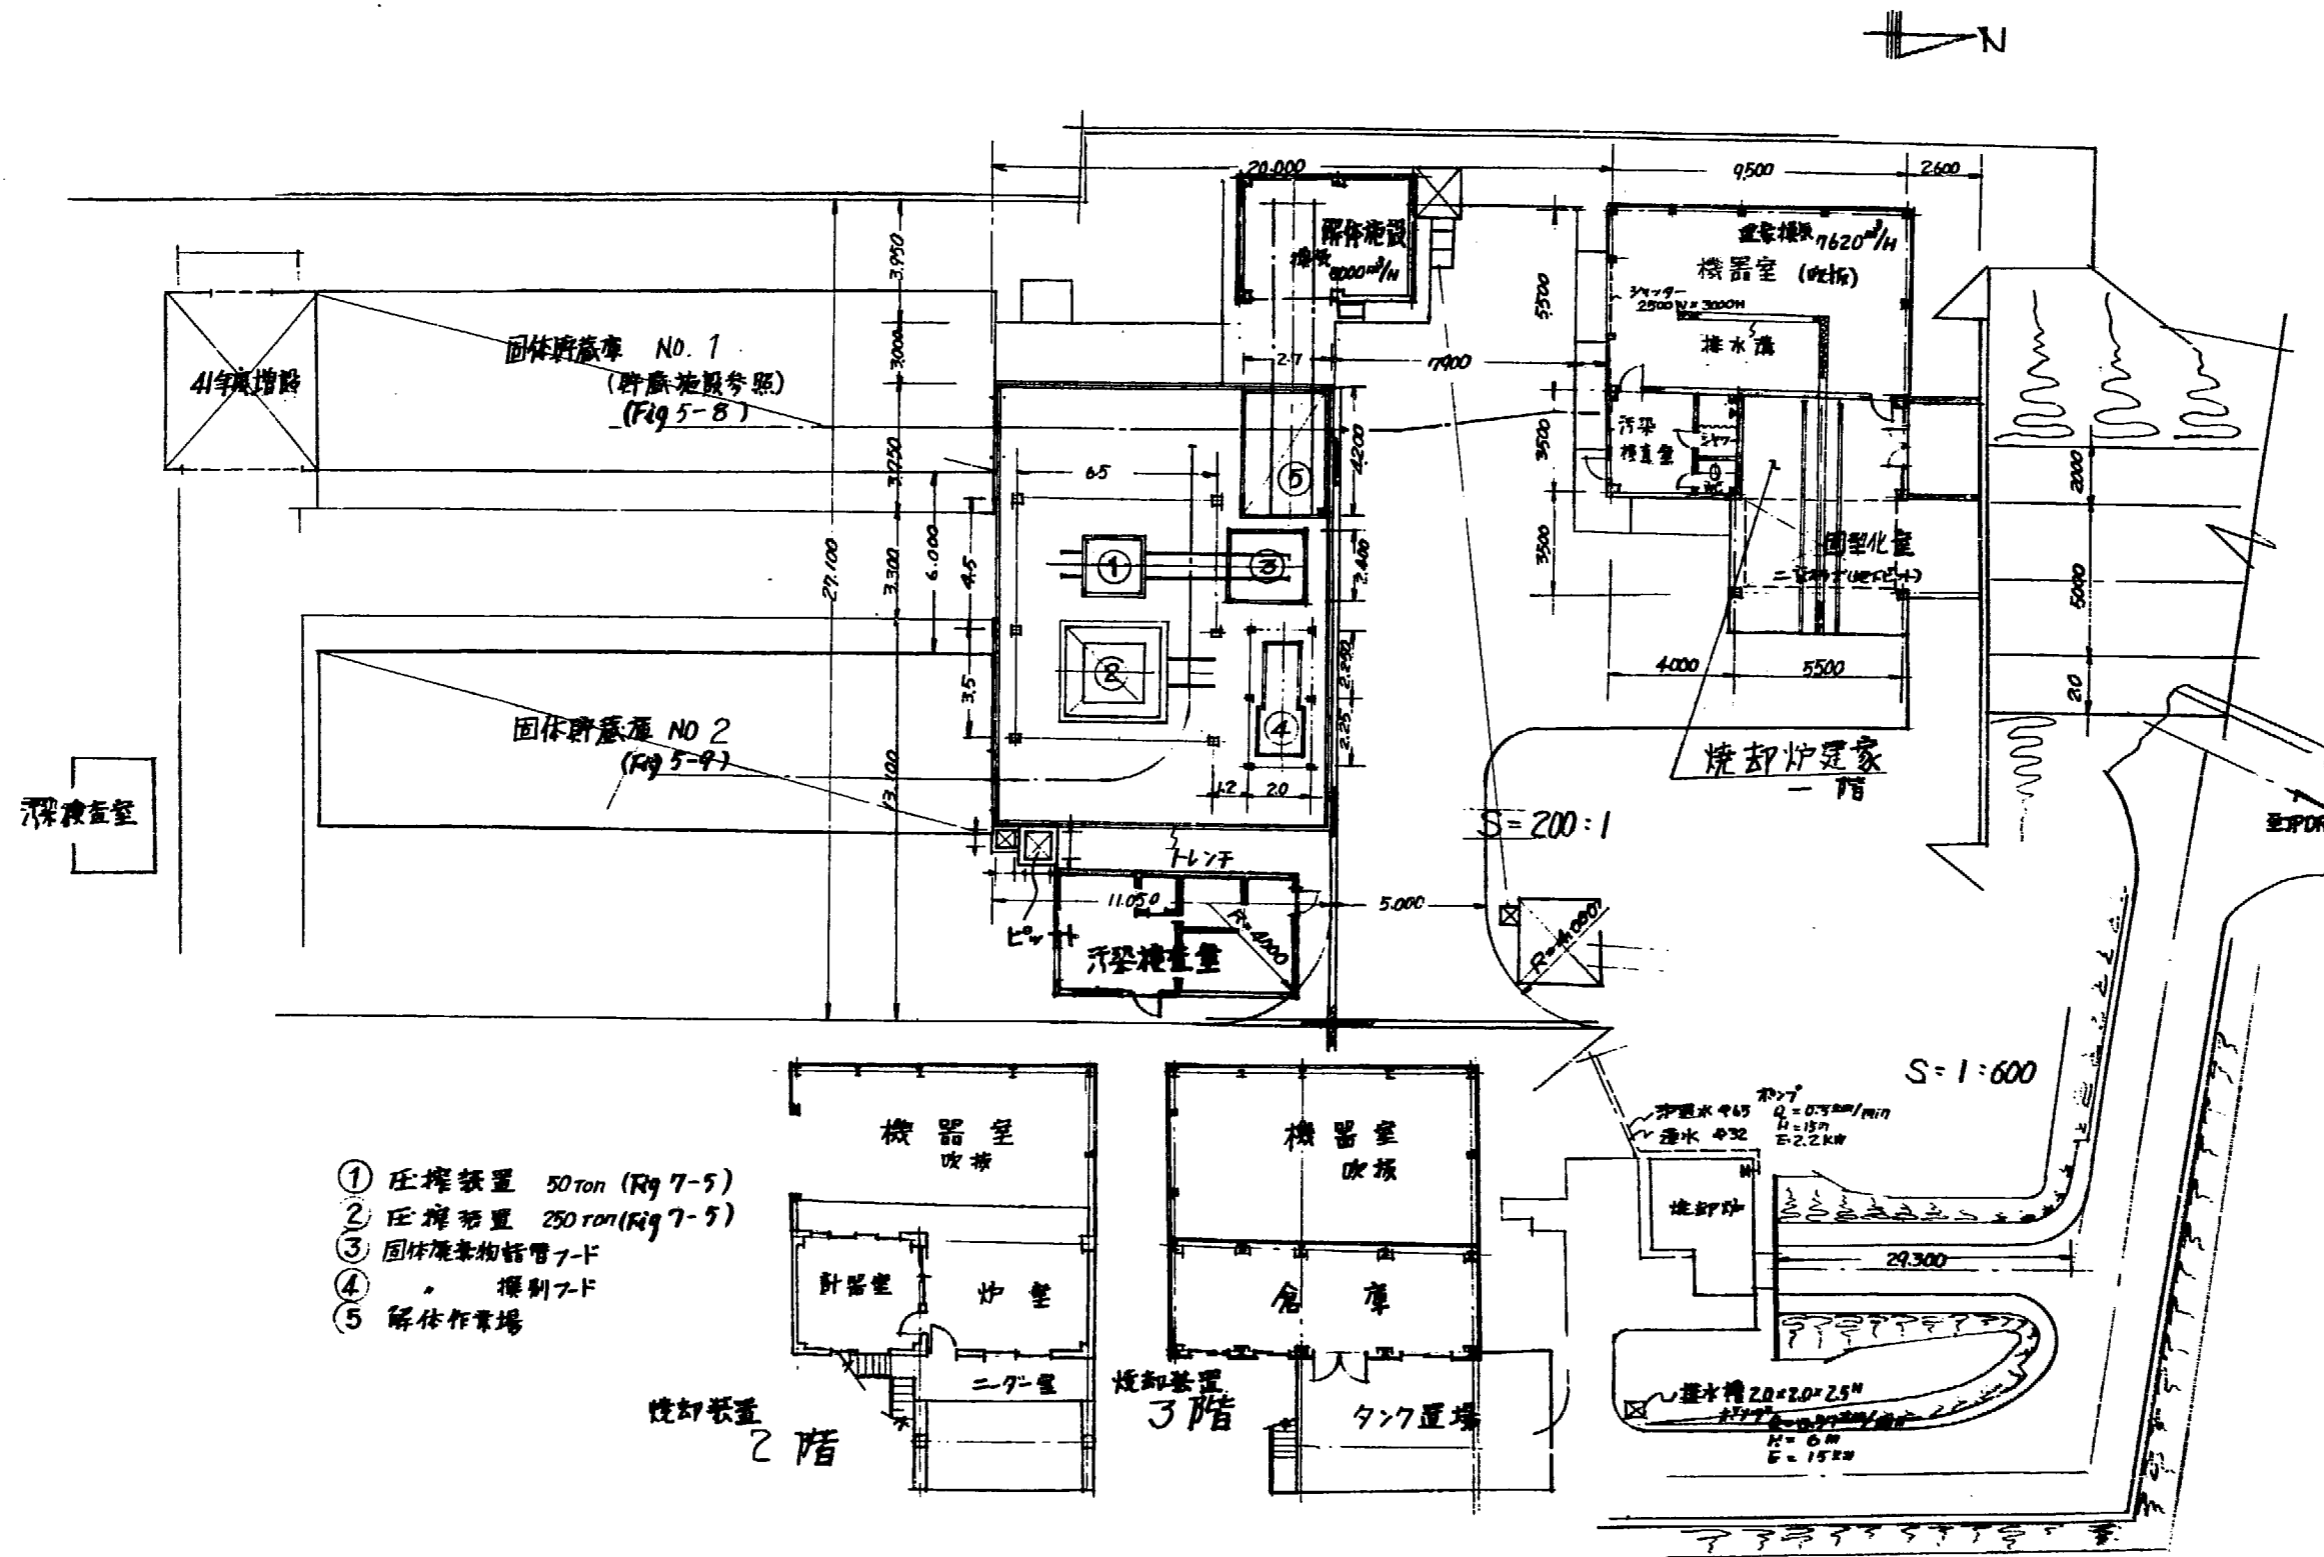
固体廃棄物の貯蔵および処理施設周辺配置図
